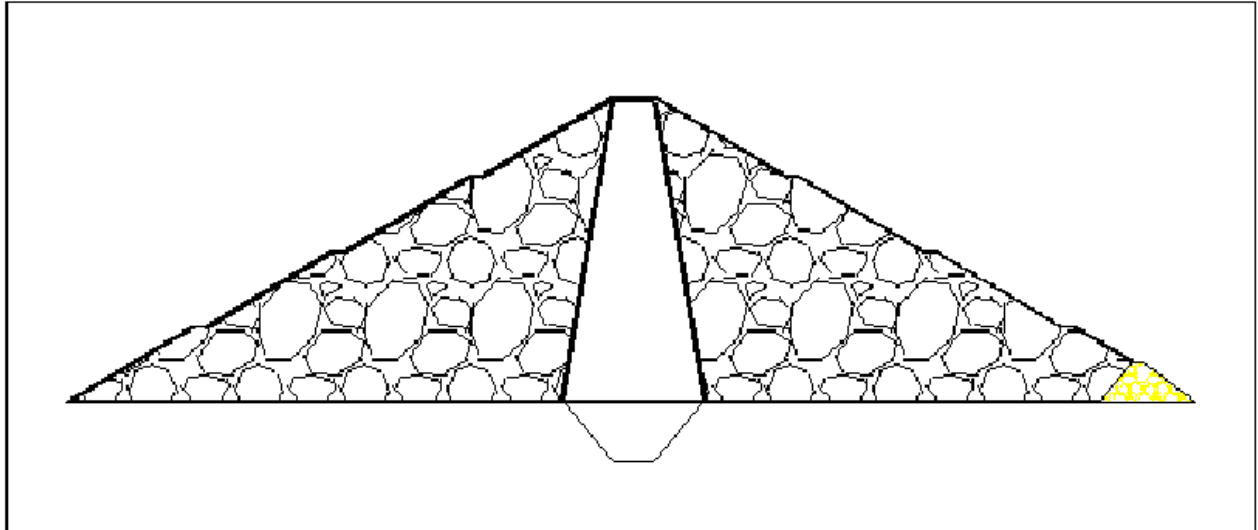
coupe type d'une digue en enrochement à noyau argileux
